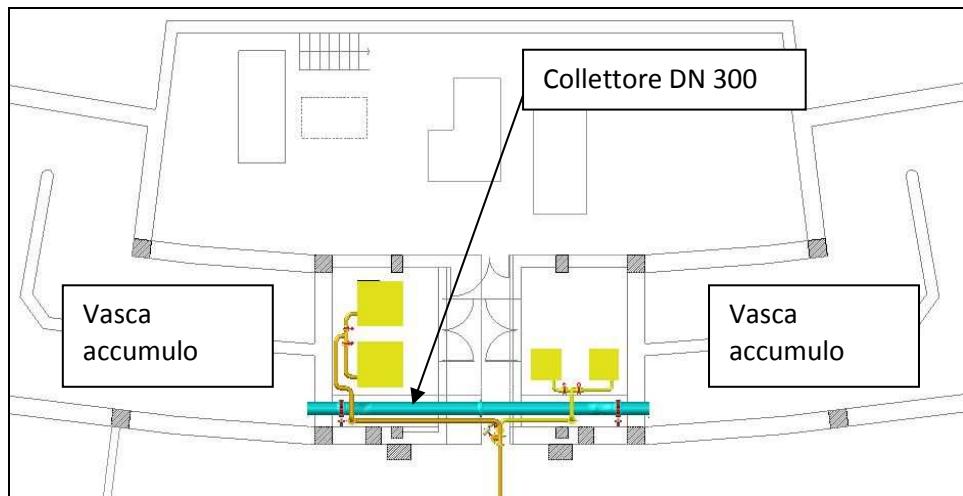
estratto pianta piano terra: collettore collegamento idraulico vasche accumulo
